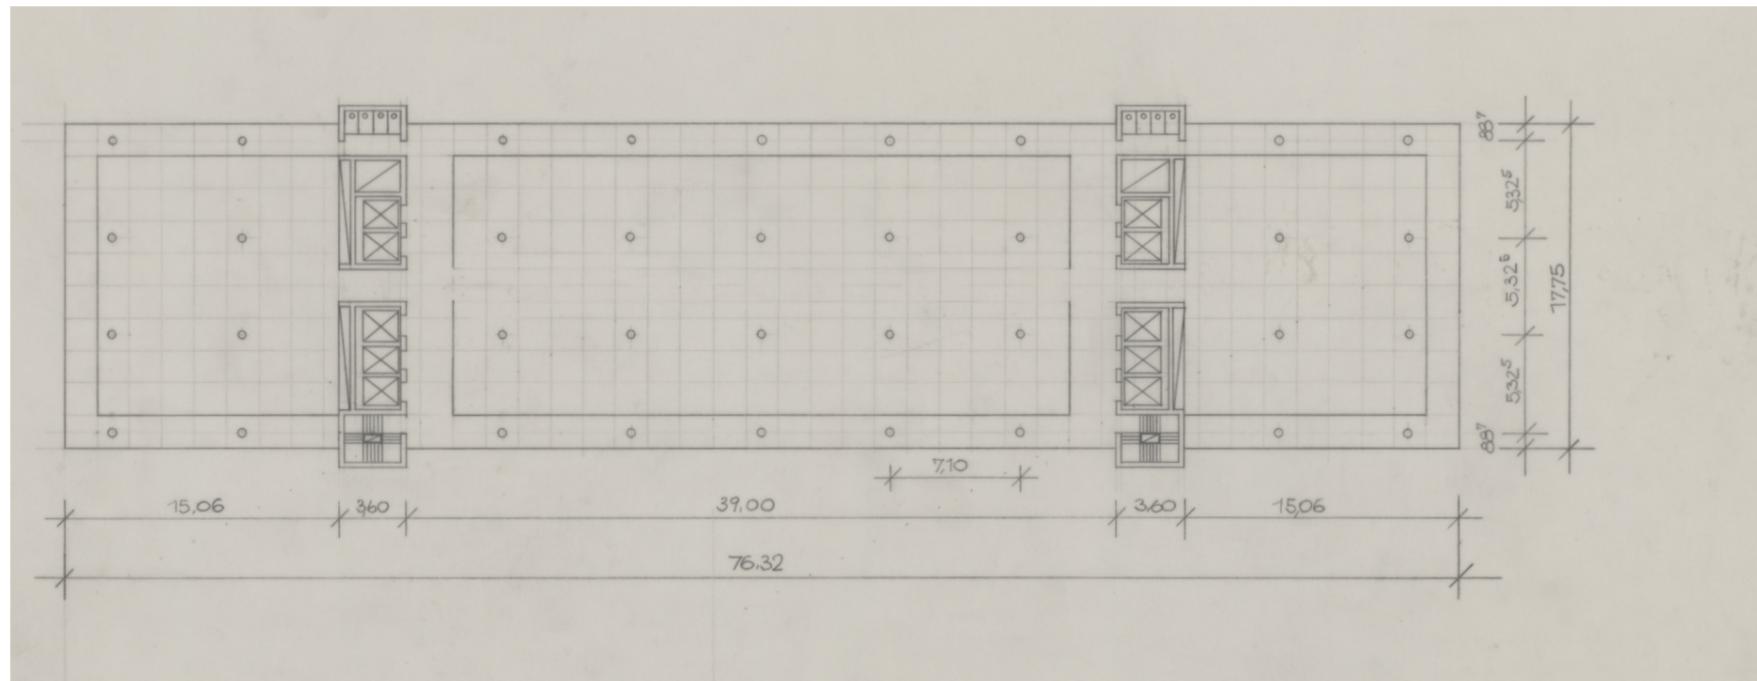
Bürogeschosse mit Innenraumzonierung (Grundriss), 1:200, 19.1.1961
